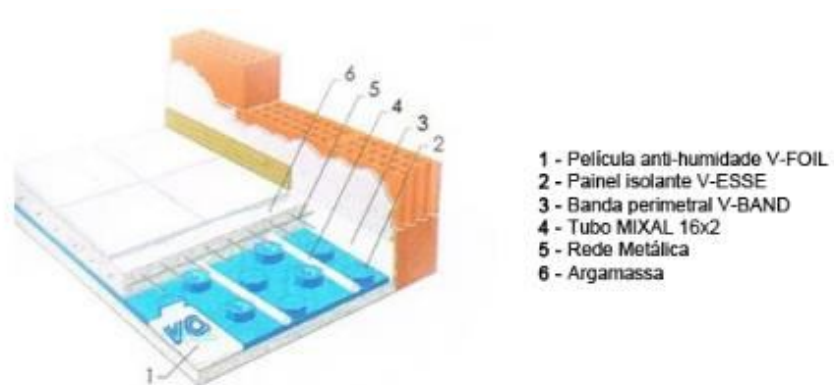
Pormenor de pavimento radiante hidráulico (Solarwaters, 2016)
